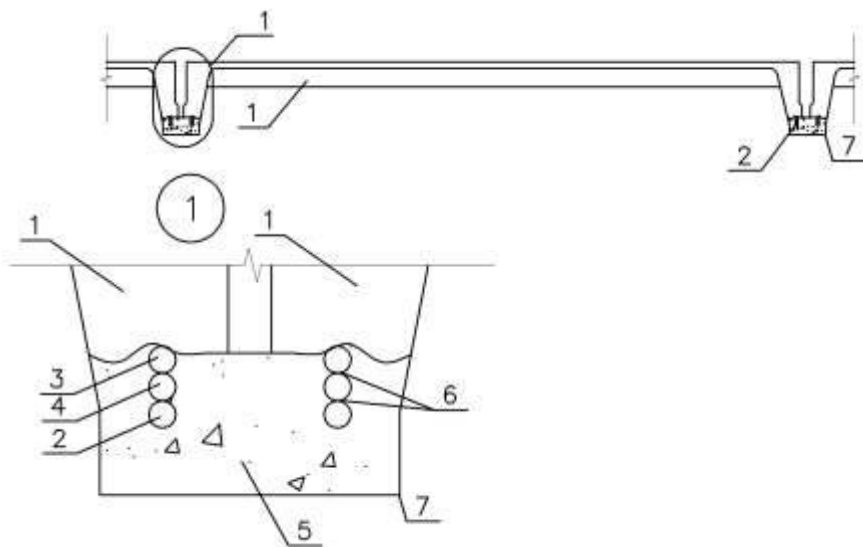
Установка дополнительной арматуры в растянутой зоне
